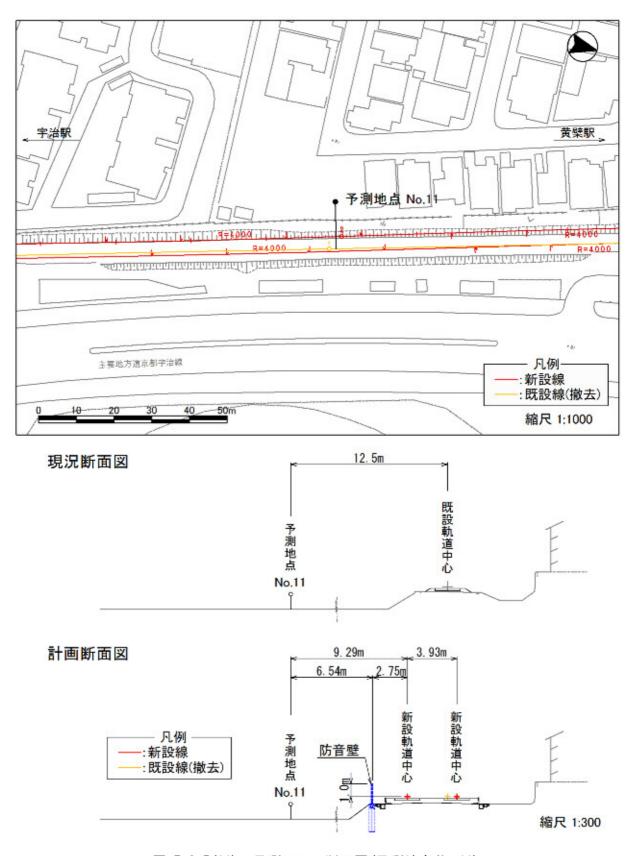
(11) 予測平面・断面図(予測地点 No.11)
